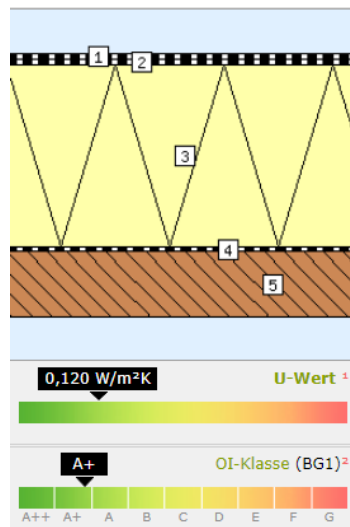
Konventioneller Bauteilaufbau, Flachdach aus Holz
